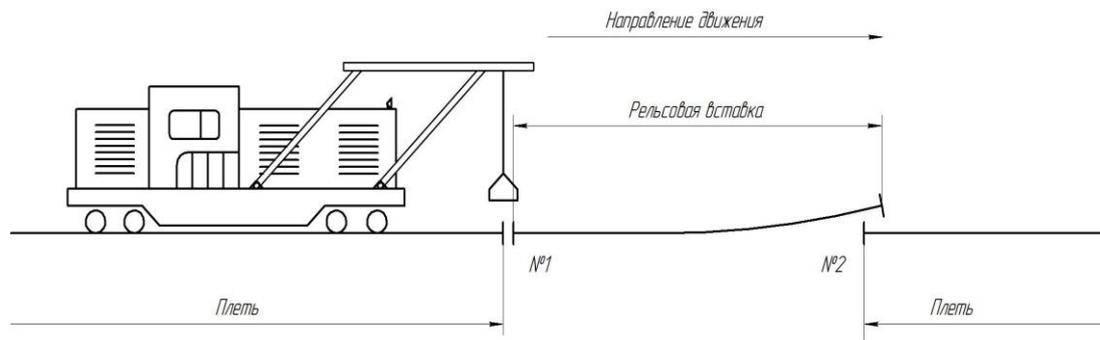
Схема размещения ПРСМ и рельсовой вставки в месте сварки
